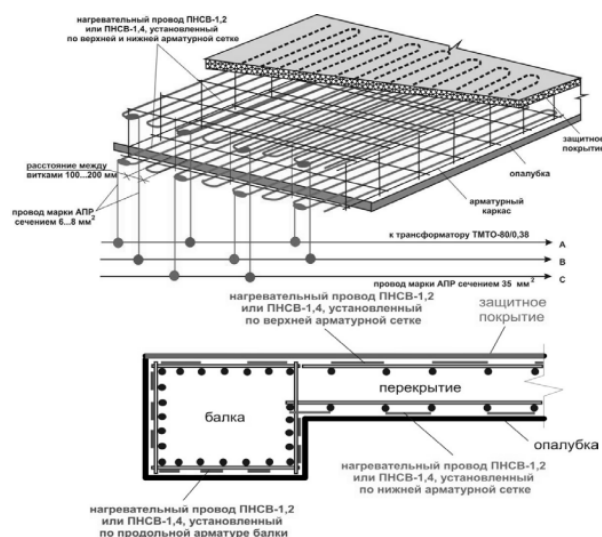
Принципиальная схема раскладки нагревательного провода при прогреве балок перекрытий
